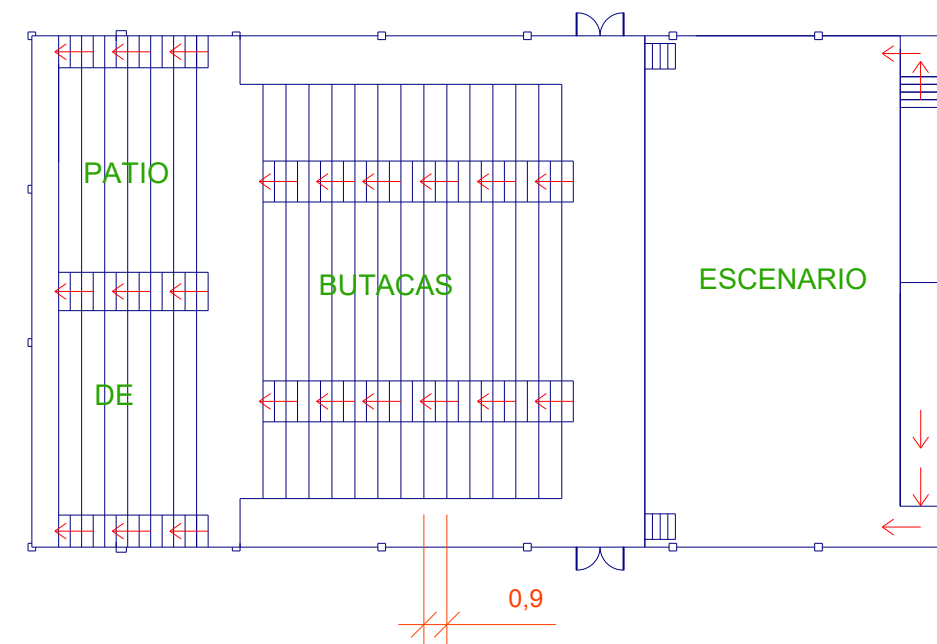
Distribución en planta de la Zona 2 del edificio.
